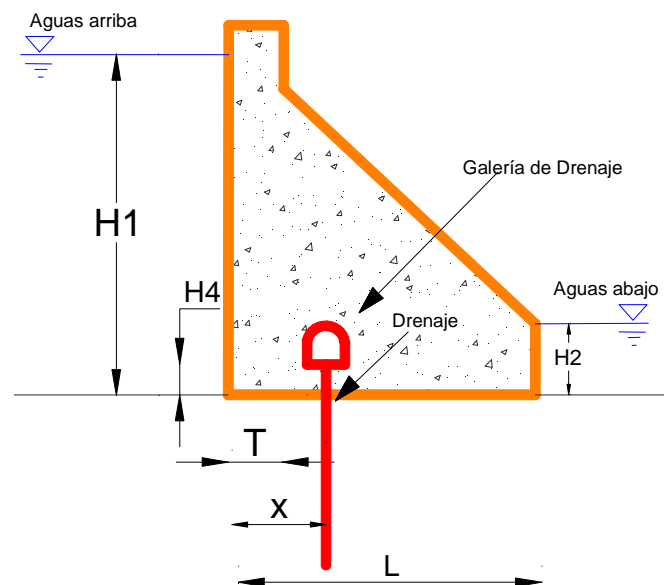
Subpresión con sistema de drenaje y fisuramiento (Fuente USACE)
